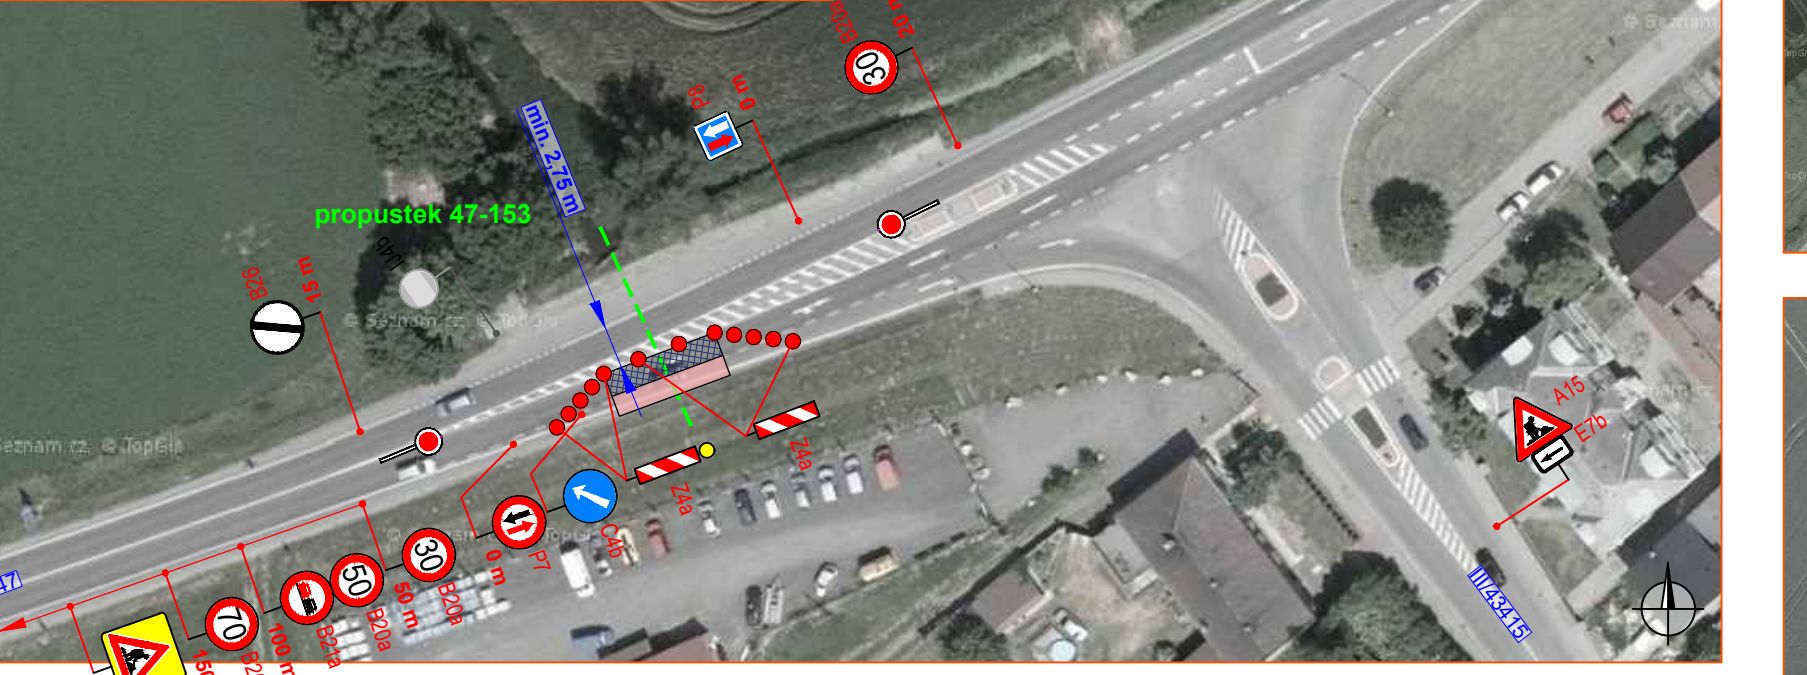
LEVÝ JÍZDNÍ PÁS
